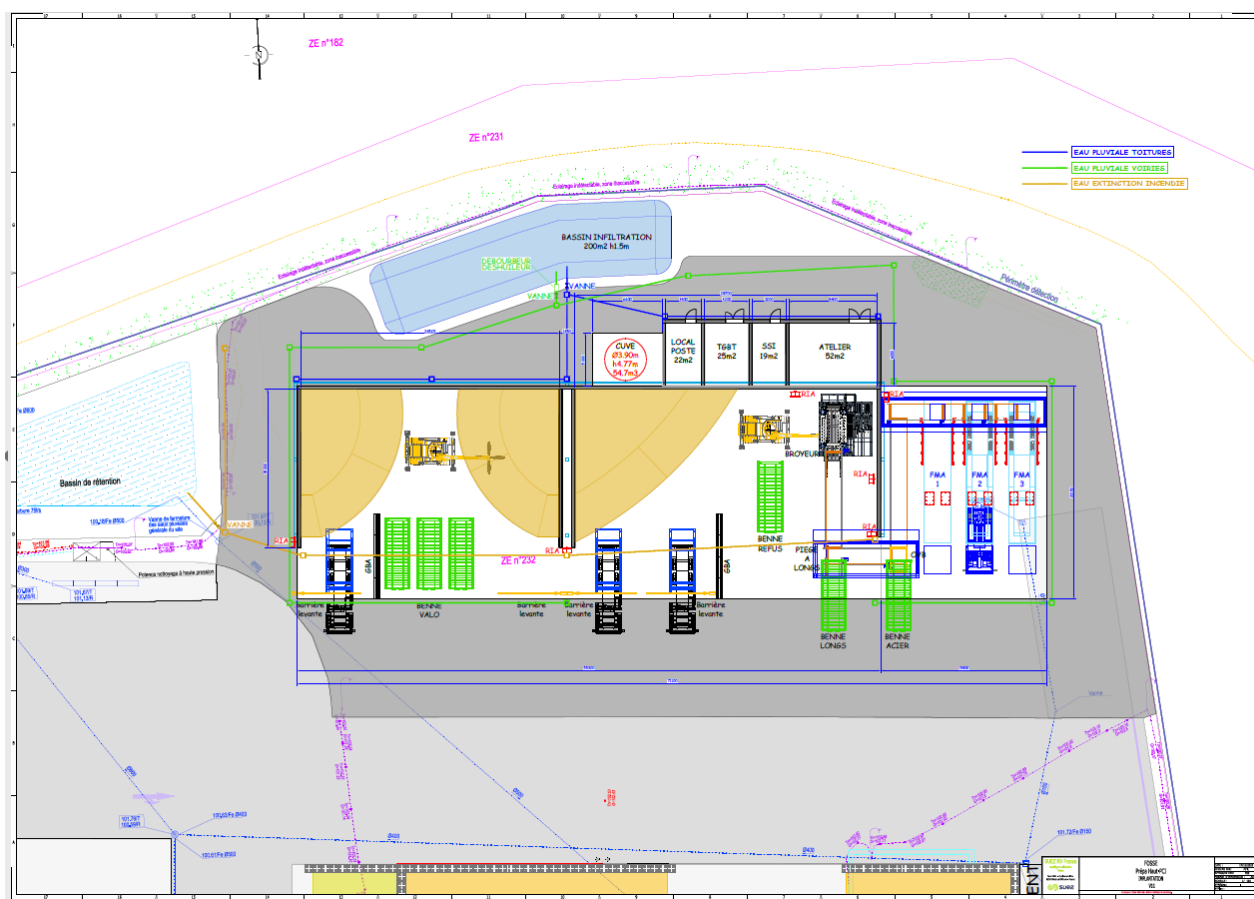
Plan d'implantation du nouveau bâtiment (exemple de configuration, stockage DAE et TVD non optimums)
